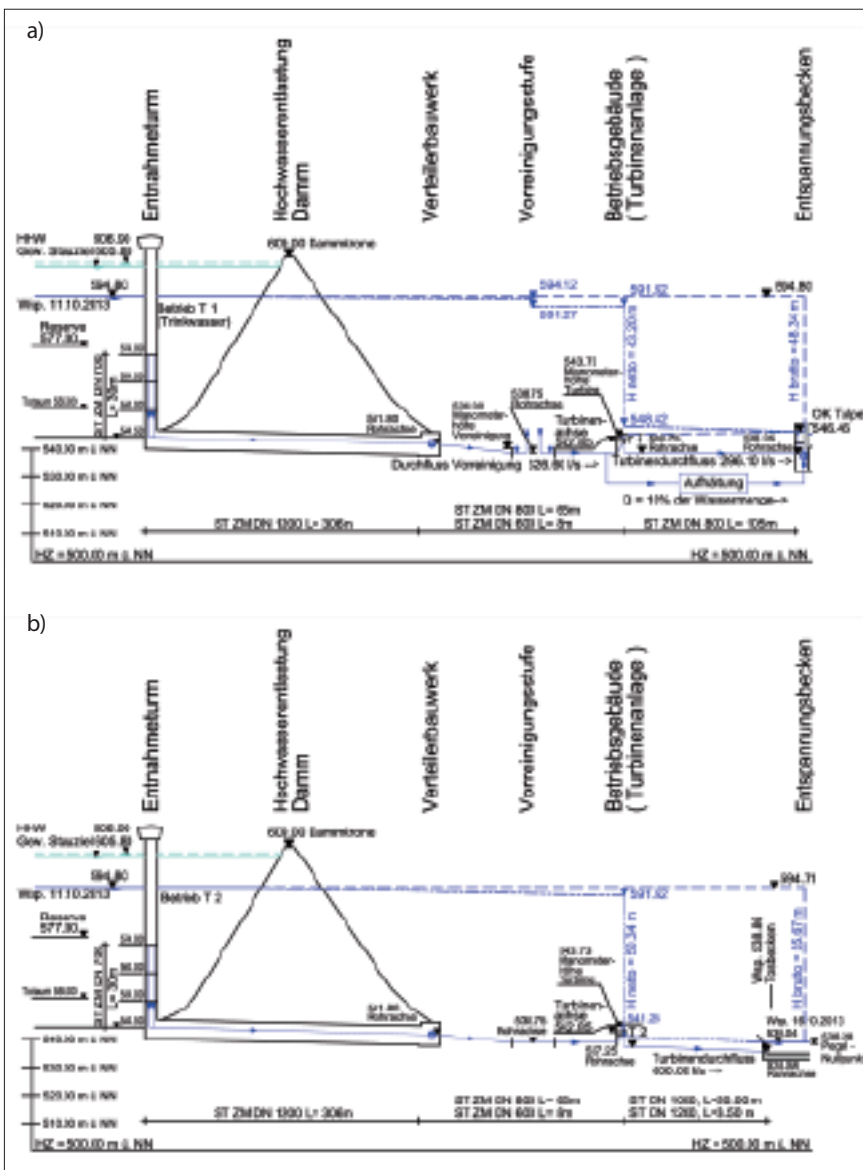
Hydraulisches Funktionsschema, a) Leitungsstrang 1, b) Leitungsstrang 2 (Quelle: Autoren)
